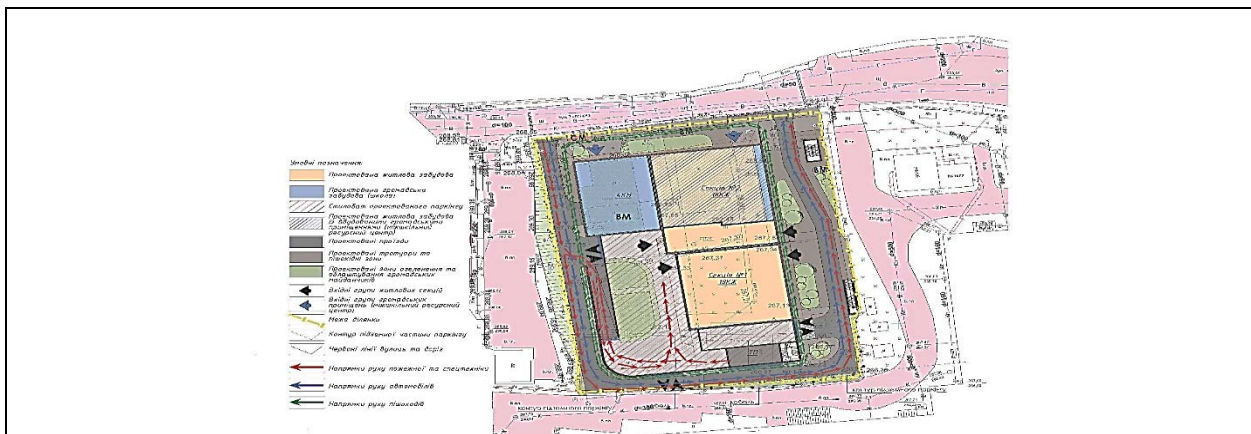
ЖК у Львові на вул. Топольній, 4. Схема функціонально-планувального вирішення об'єкту
